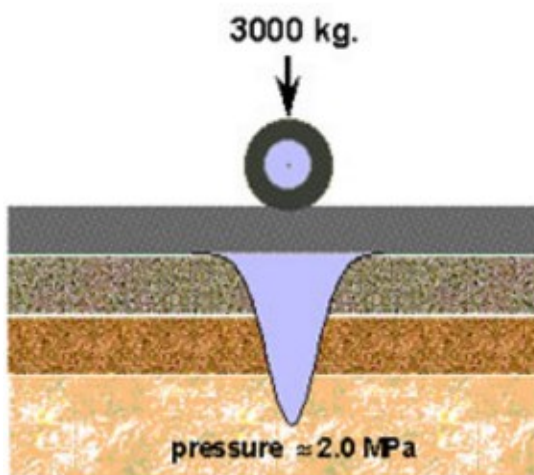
1. Distribuzione delle tensioni in una pavimentazione flessibile.
